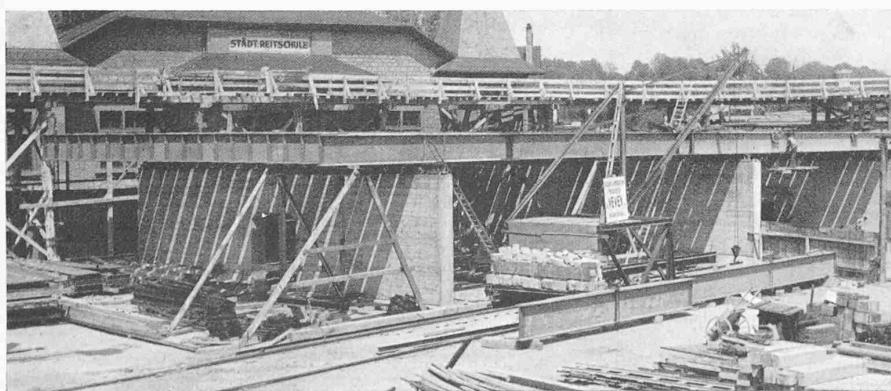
Trägerdecken des Loses 5 auf Eisenbeton-Pendelwänden. Durchgehende Träger Die 100, verstärkt durch aufgeschweißte Lamellen aus St 44
